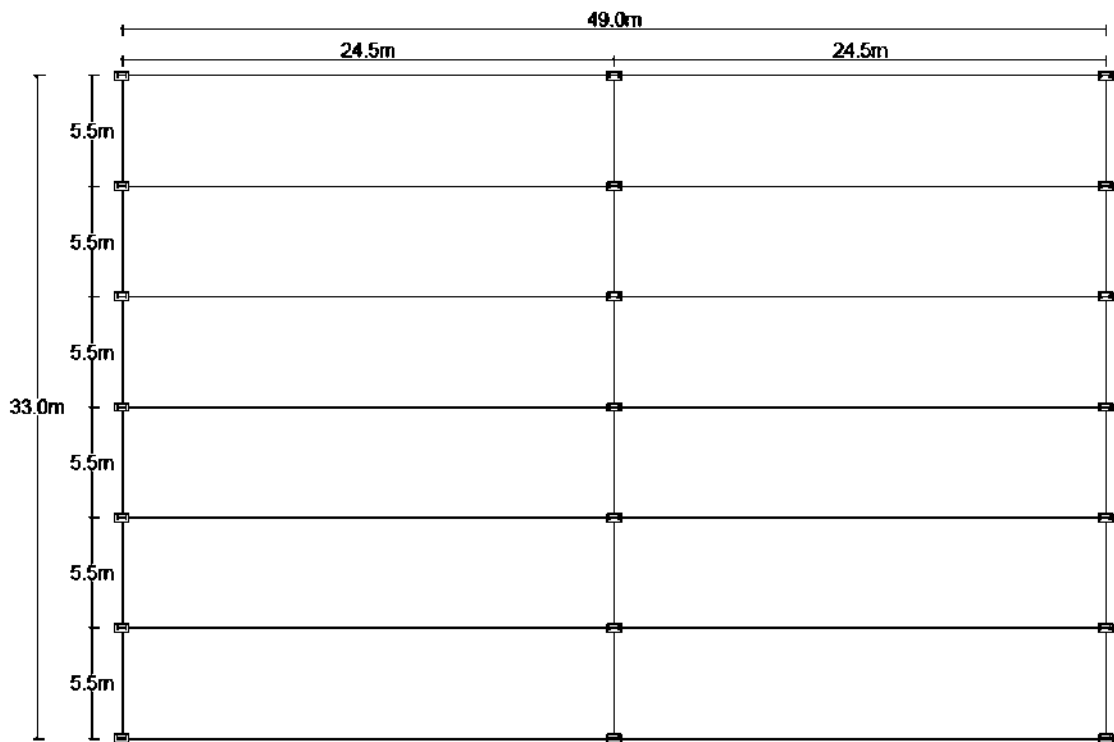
(b) Dimensiones de elementos de cimentación y cubierta vista en planta, (metros)
